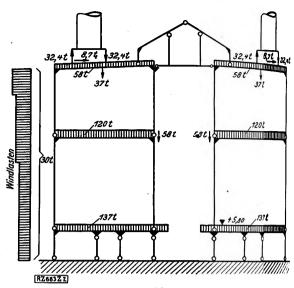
Kesselhaus-Querschnitt mit Dach-, Bühnen- und Windlasten für einen Binder
